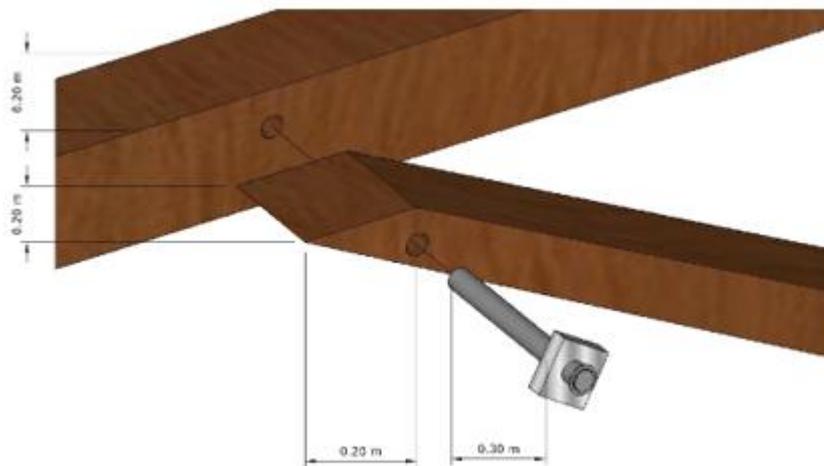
81 Detail C pada sambungan kepala bangunan pada zona I
